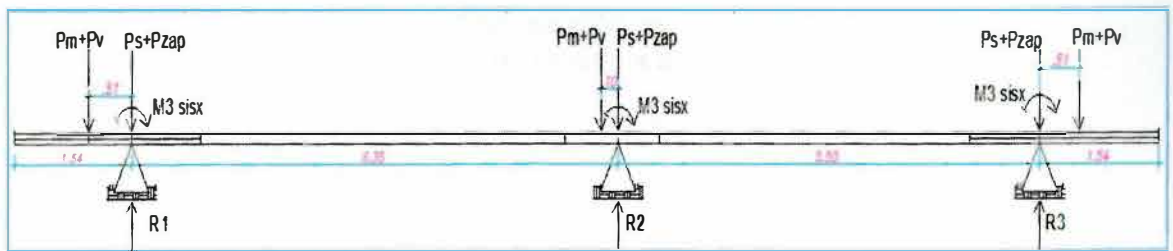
Modelo Simplificado de viga de conexión y zapata Z3 - Z4 - Z3
